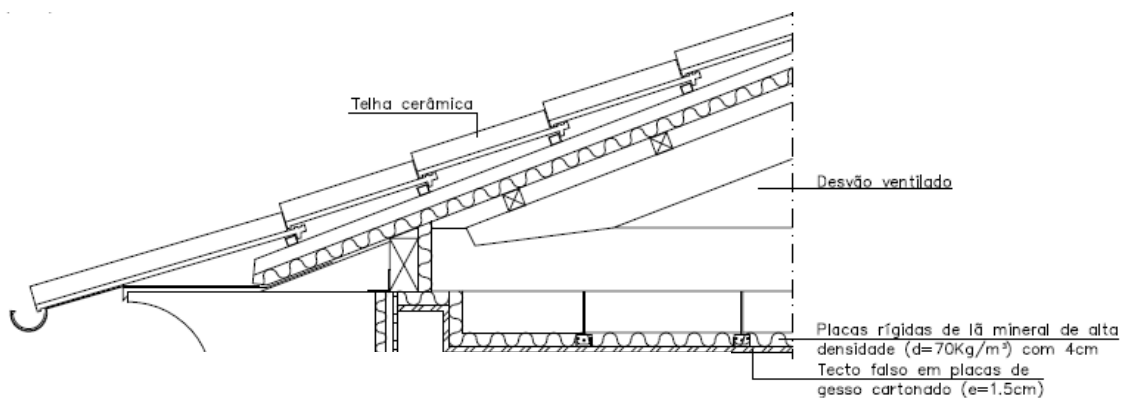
Pormenor da cobertura e teto do 3º piso [19]
